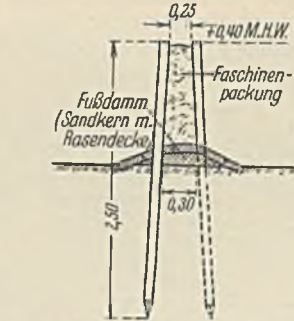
Querschnitt einer leichten Buschlahnung.
